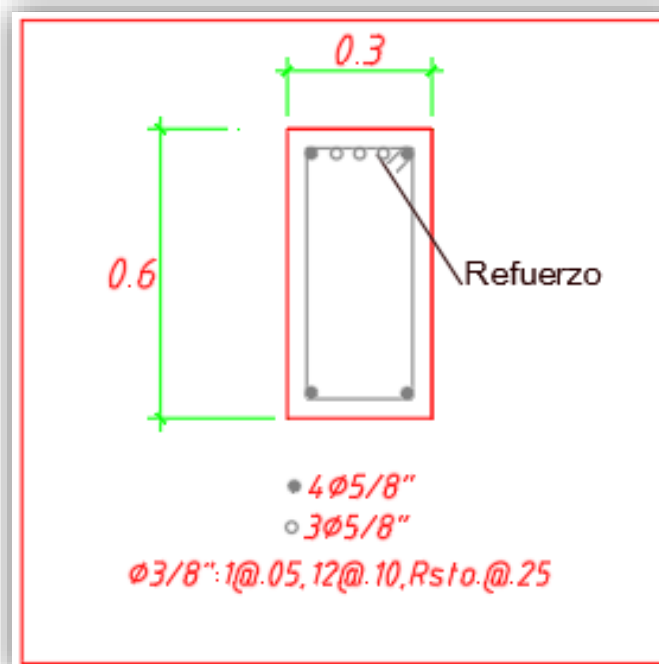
Detalle de refuerzo en vigas pisos 1 al 3
